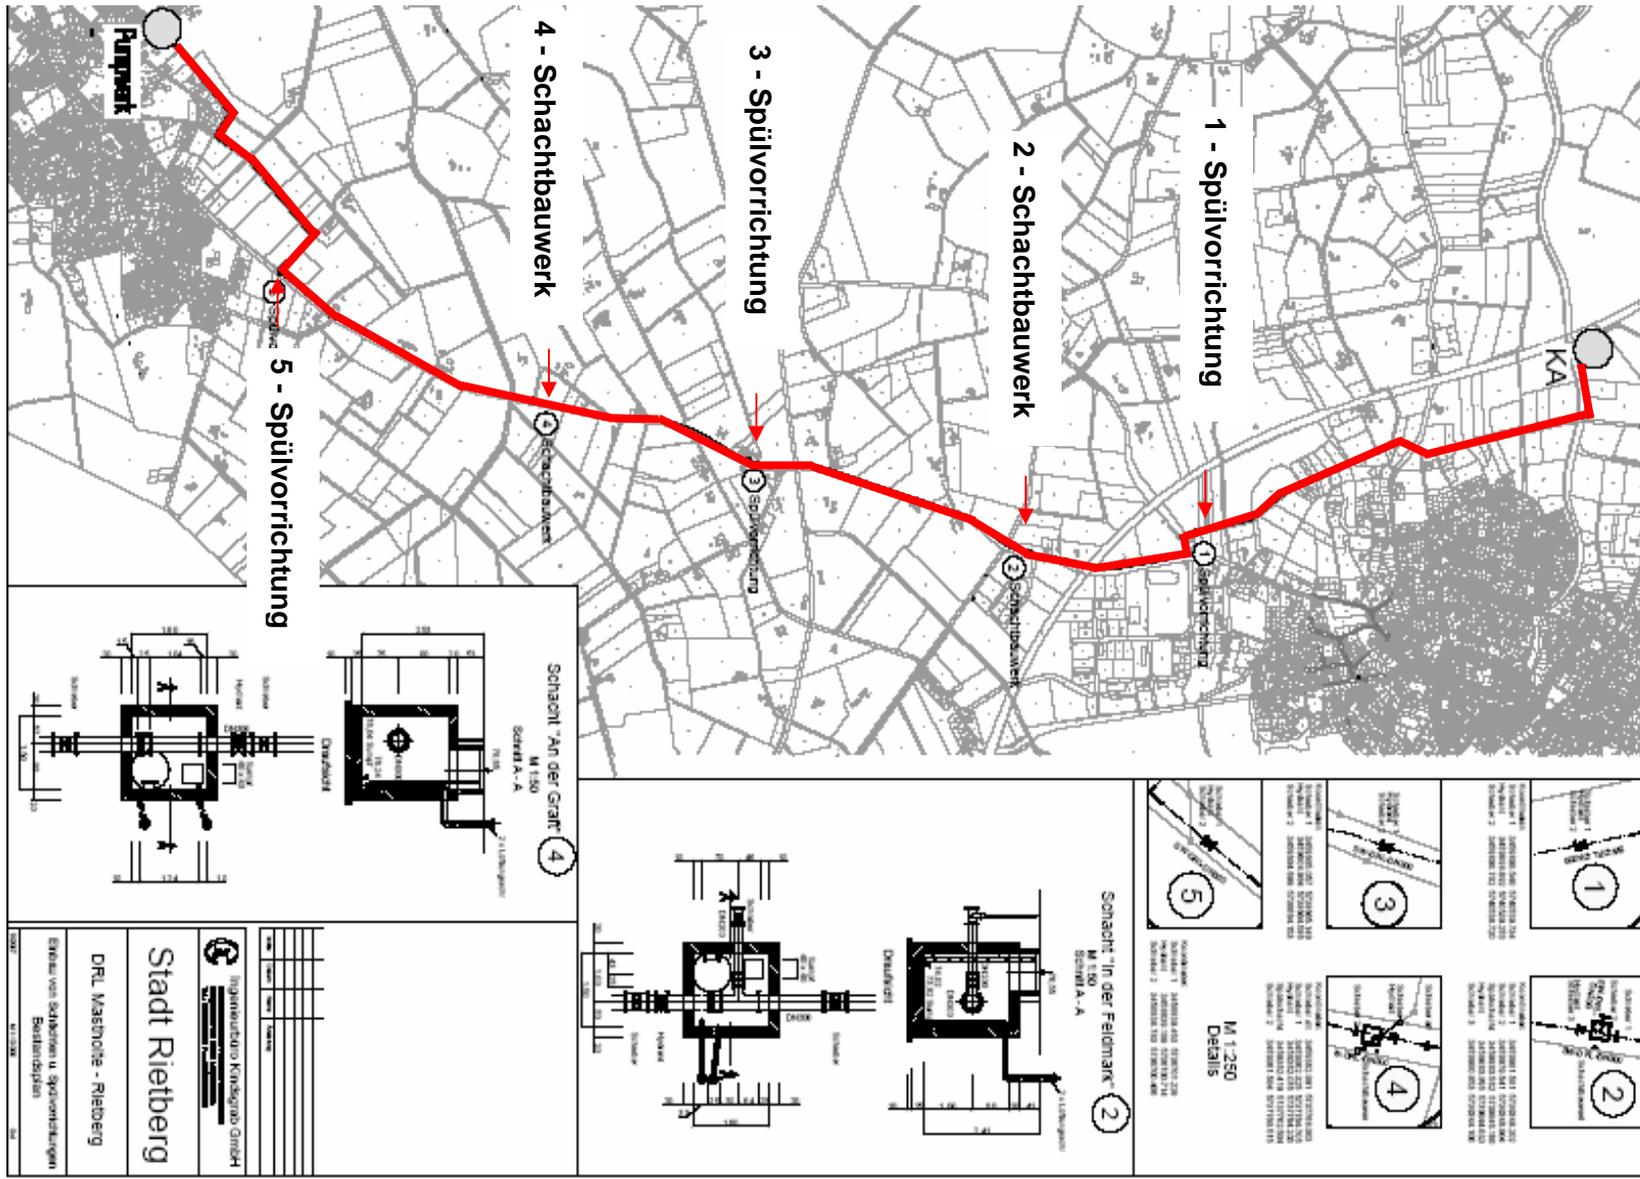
Lageplan Druckleitung Guss DN 300, Länge 7,5 km, Rietberg
